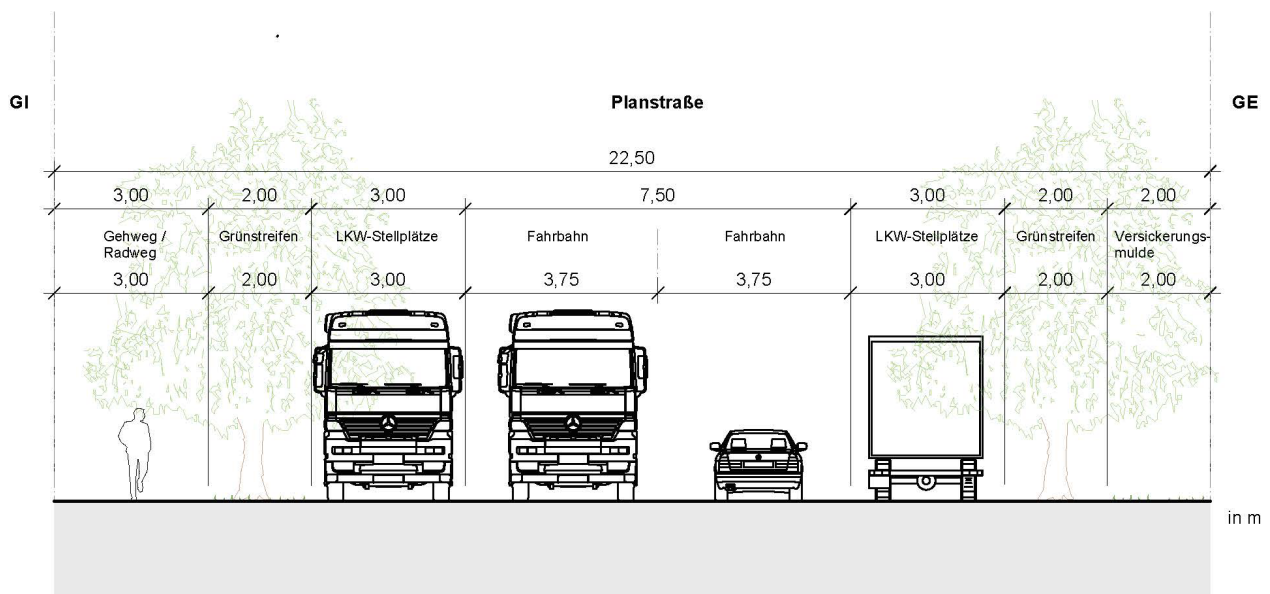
Regelquerschnitt einer möglichen inneren Planstraße, maßstabslos © BCE
